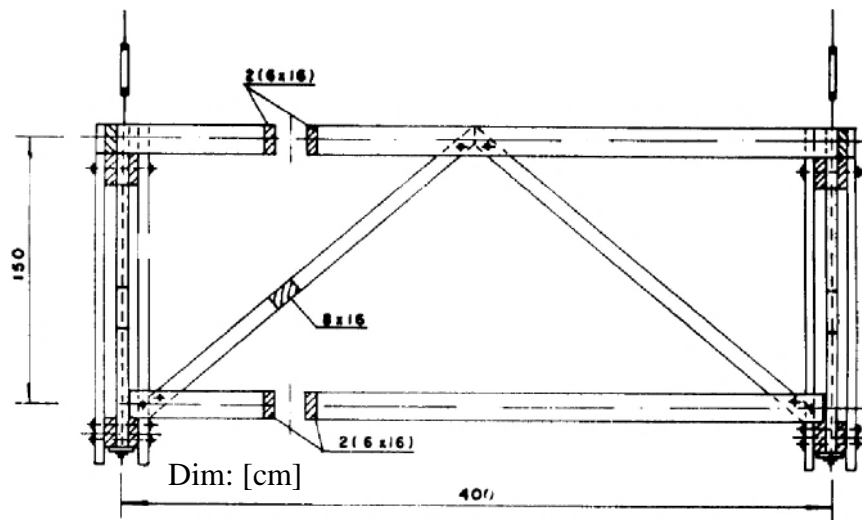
Corte AA (Revista Madeira, 2001)
